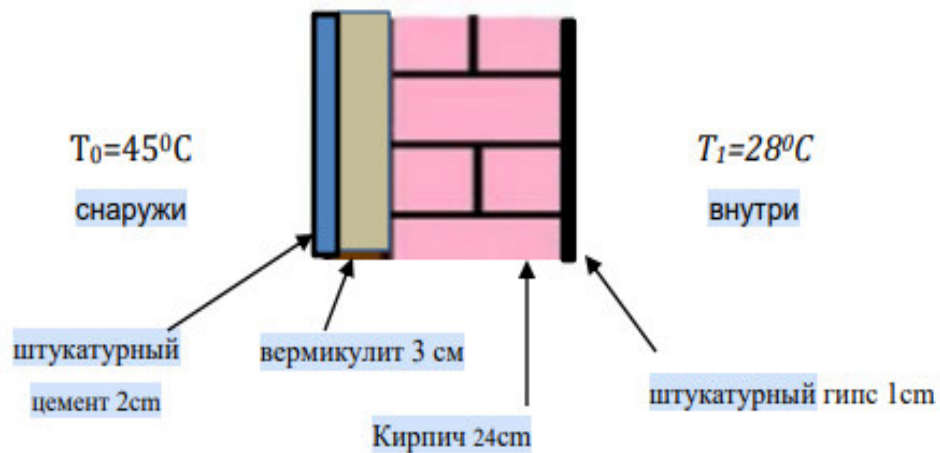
Схема кирпичной теплоизоляционными слоями
